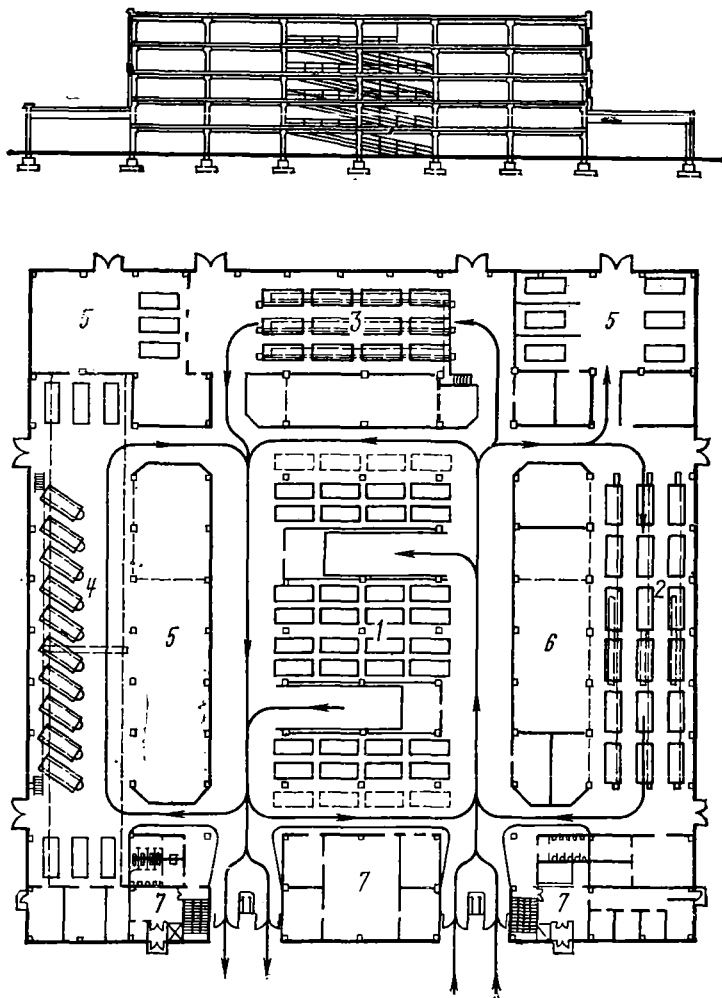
Таксомоторное предприятие на 650 автомобилей-такси (план 1-го этажа и разрез пятиэтажного здания):
